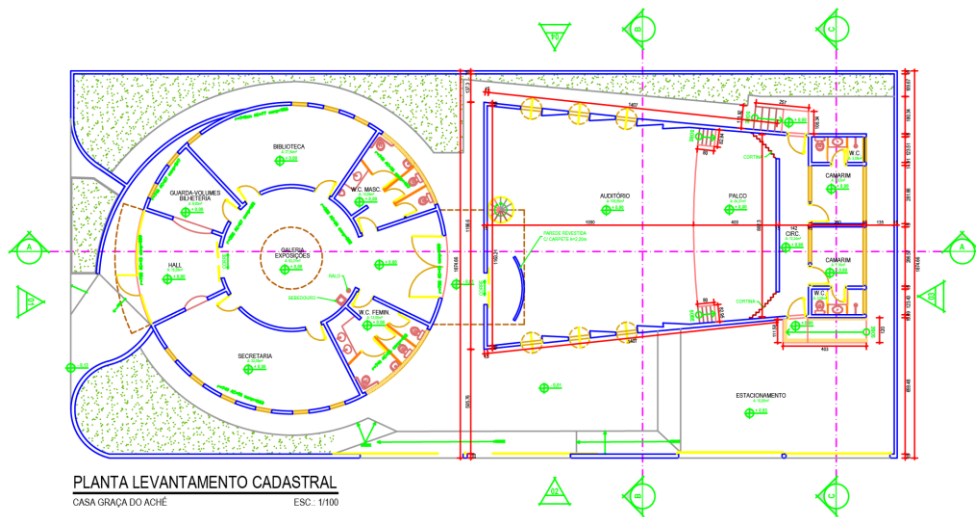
Planta do edifício. Diretoria de Obras - UFU
